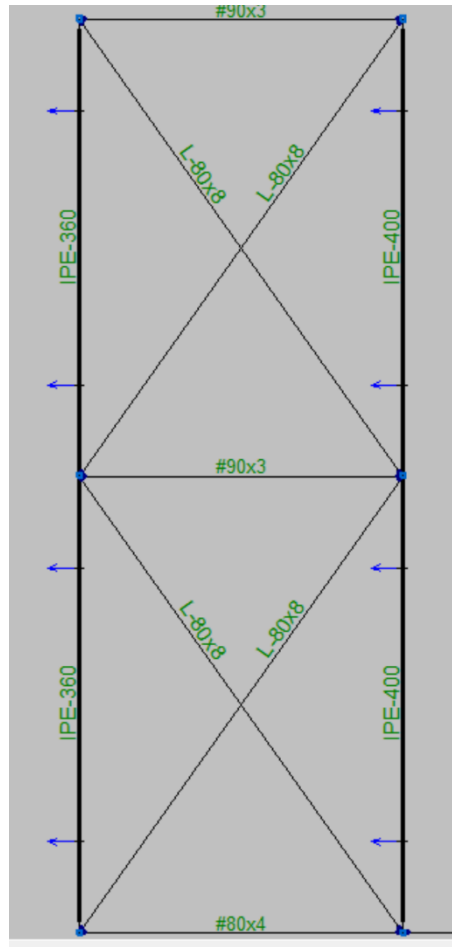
Arriostramiento cubierta con detalle elementos constructivos.
